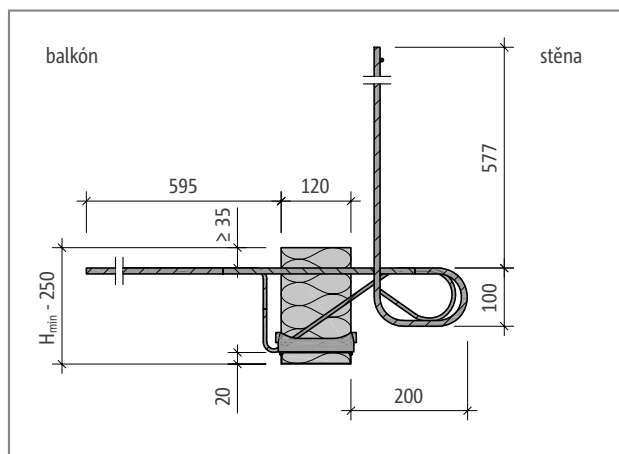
Schöck Isokorb® typ KXT30-BH: Půdorys prvku
